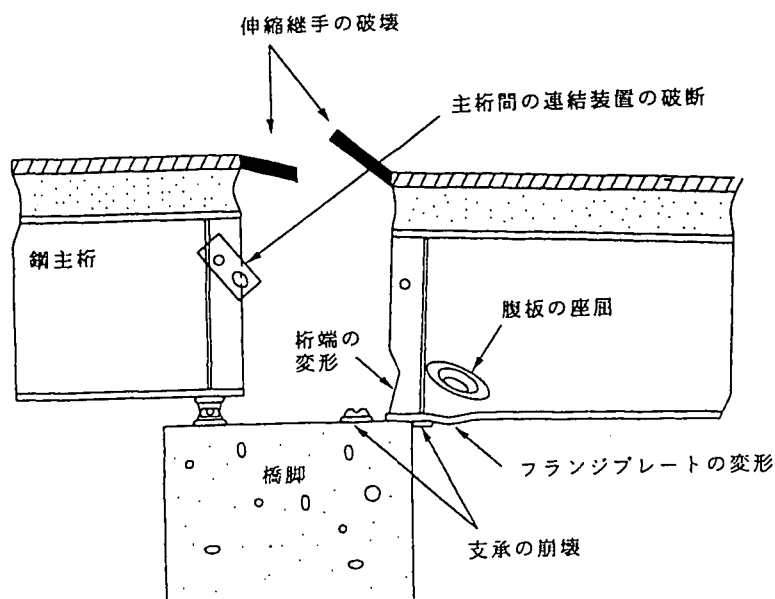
鋼主桁端部の代表的な損傷のイメージ図
